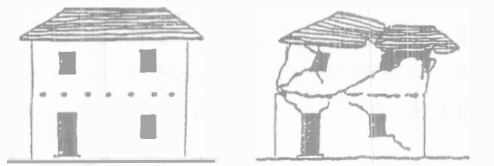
Tipos de falla en estructuras de mampostería de adobe.
